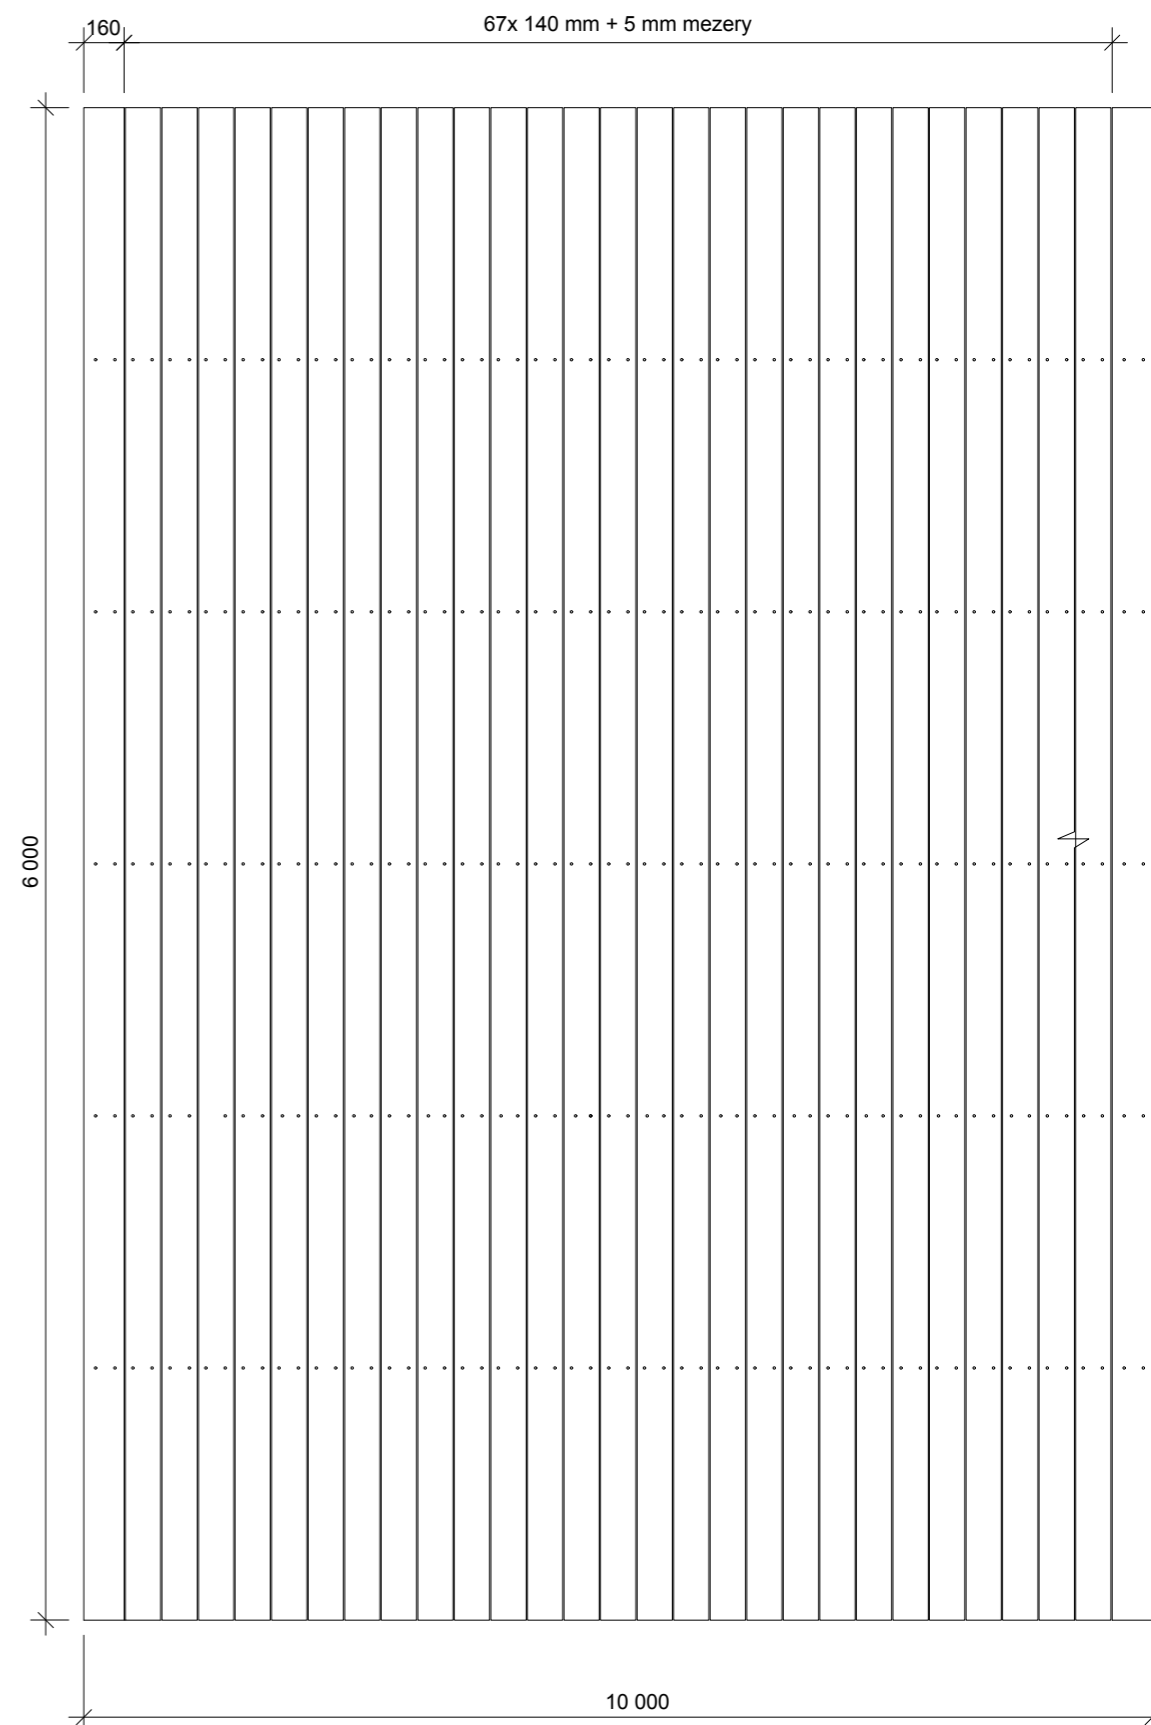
DETAIL ULOŽENÍ KONSTRUKCE M 1:50
